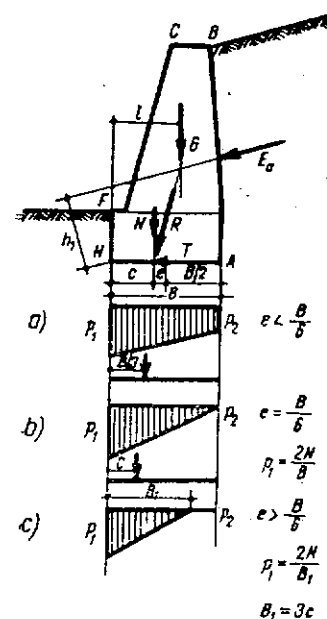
Calculul presiunilor efective pe teren la un zid de sprijin :
